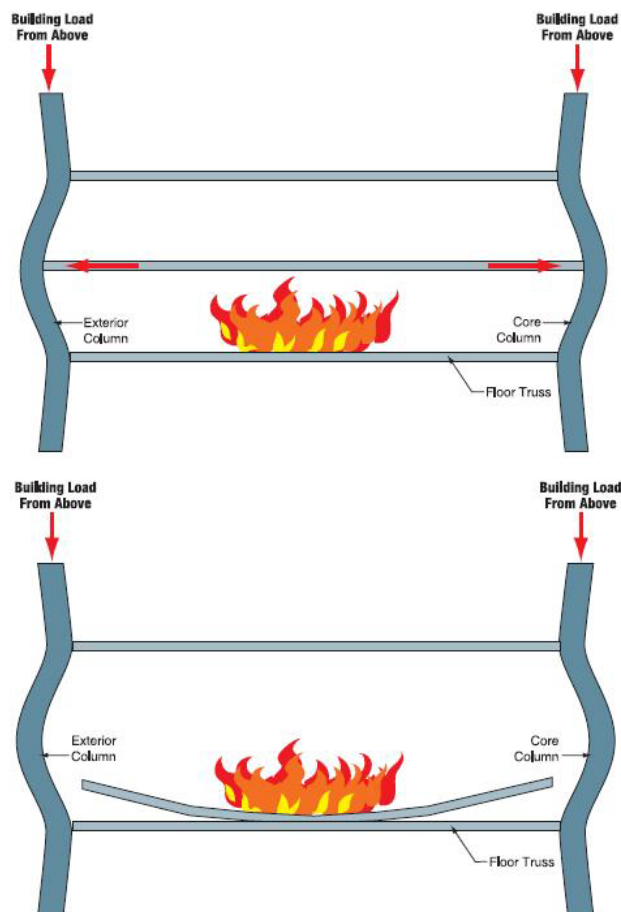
, falla estructural por fuego en losas simplemente apoyadas
